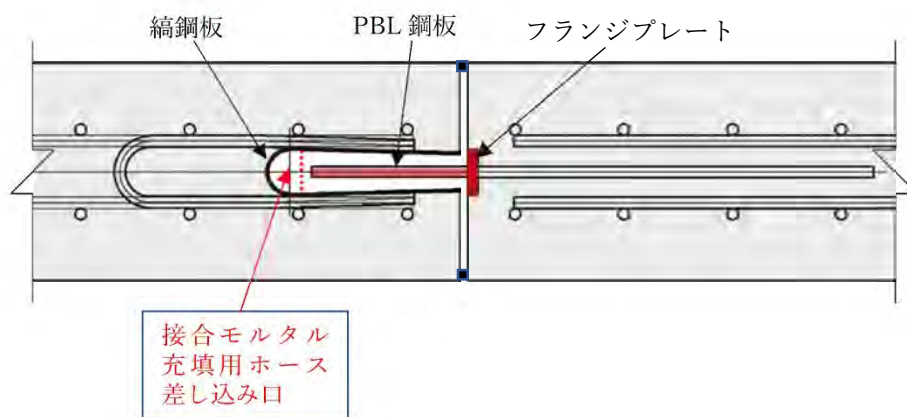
橋軸方向接合部(平面図)のモルタル充填用ホース差し込み口
